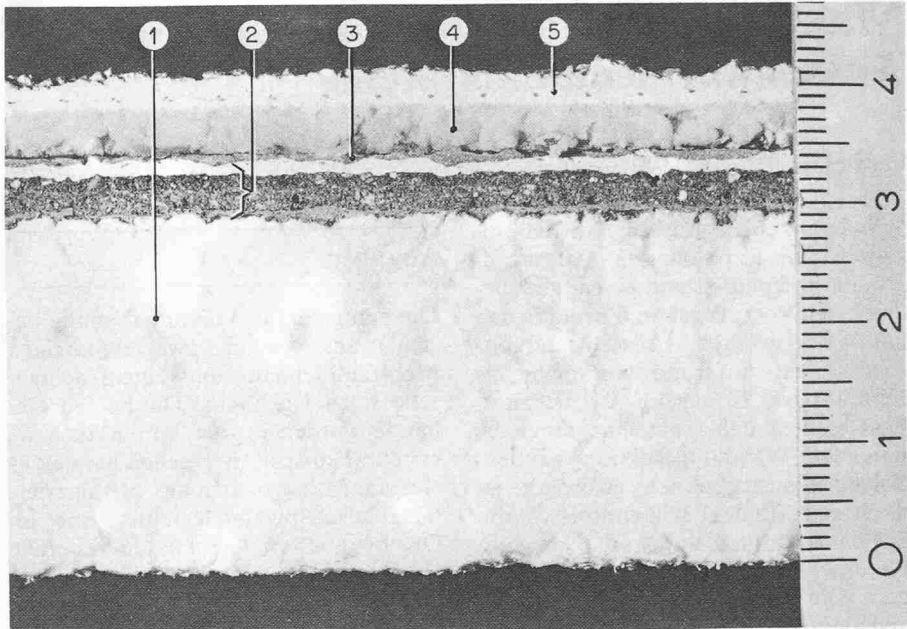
Querschnitt durch das Aussenwärmedämmsystem.
